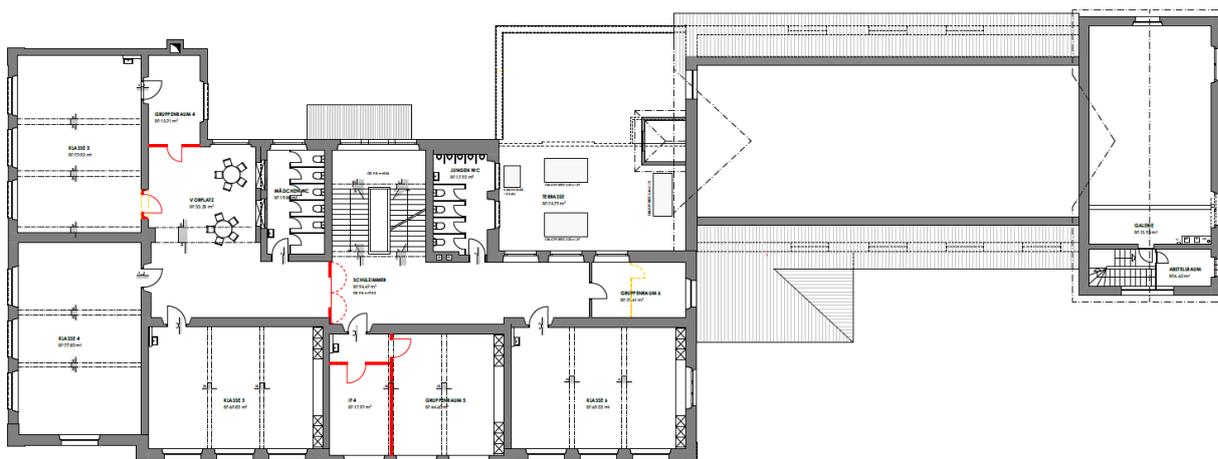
; Grundriss 2./3. Obergeschoss Haupttrakt (2. Teilsanierung)
